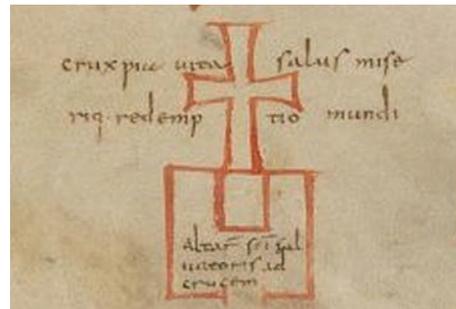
Plan de Saint-Gall, détail de l'autel de la Croix
